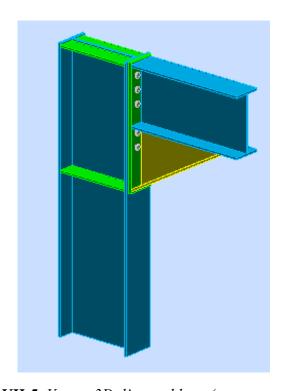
Vue en 3D d'assemblage (poteau-poutre maitresse)
